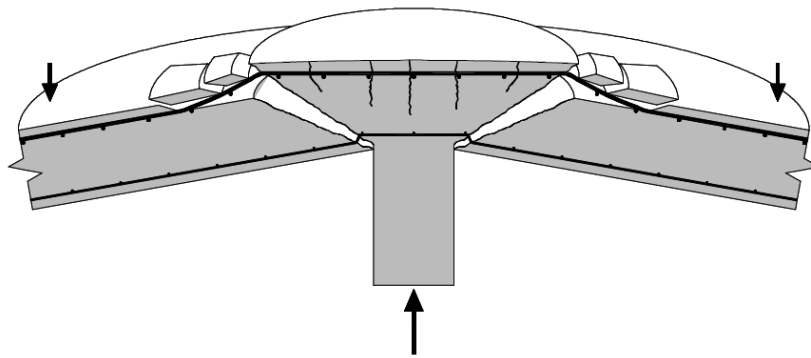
Rotura por Punçoamento de uma Laje em Betão Armado [28]
